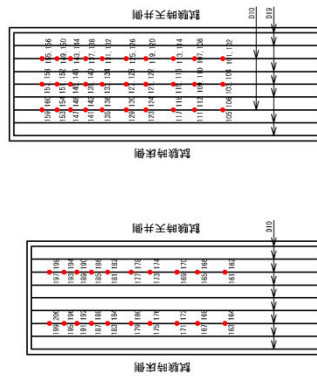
3 ヒンジアーチひずみゲージ配置図 (アーチ本体)
